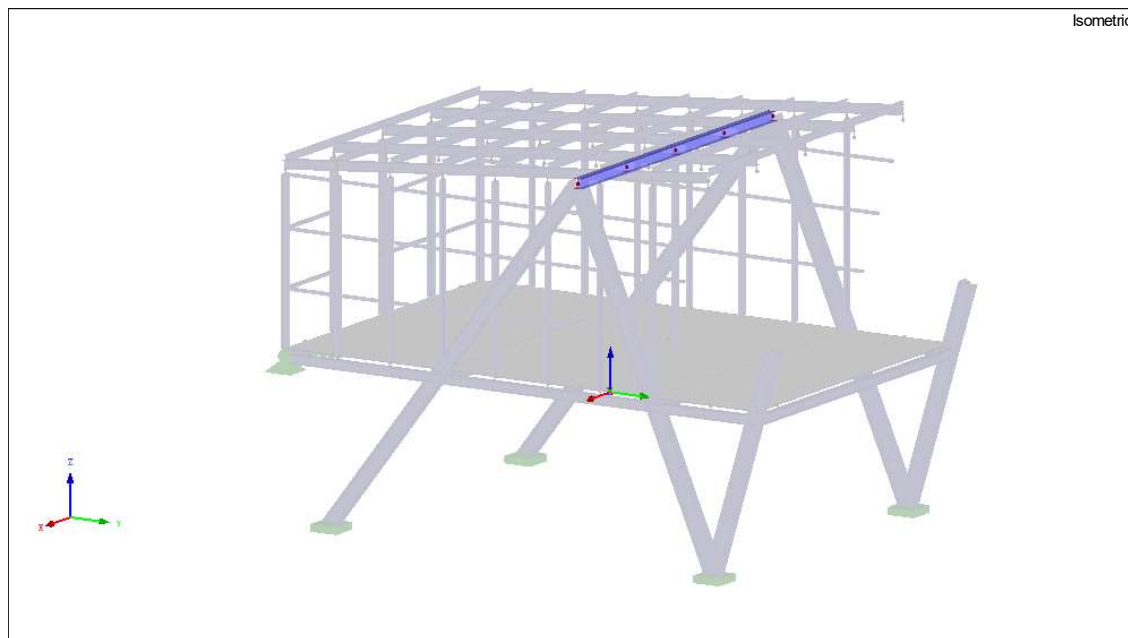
Pogled na konstrukciju sa sjeverozapada [9]
